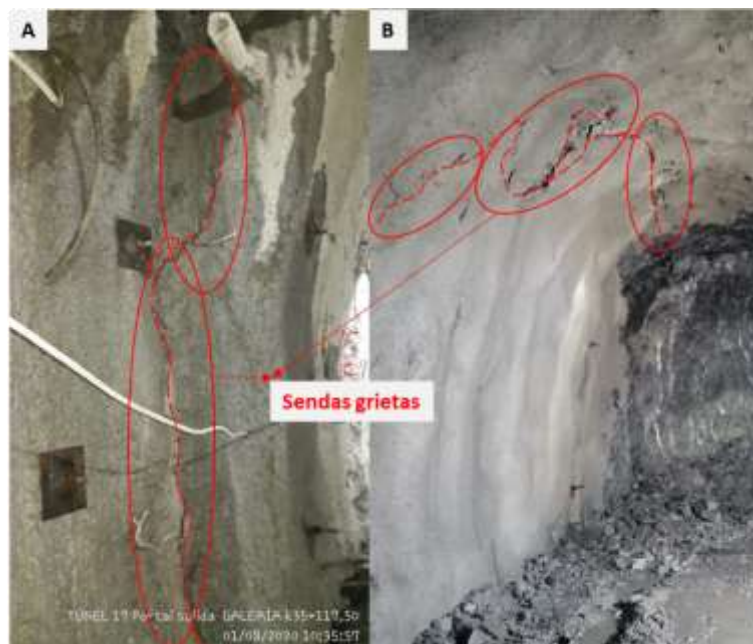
Grietas en el concreto después de aplicar el sostenimiento. A) Grietas después del sostenimiento final. B) Grietas en el sostenimiento primario. Tomado y modificado de: (INTEGRAL S.A, 2022).
